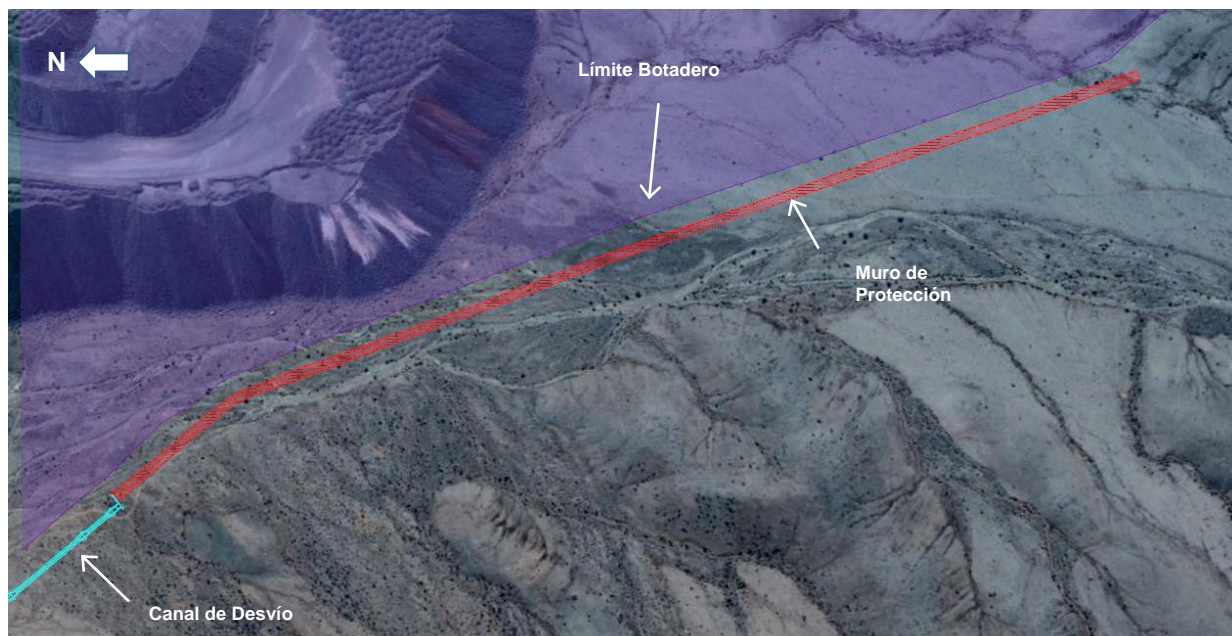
Muro de Protección - Vista del Trazado en Planta
